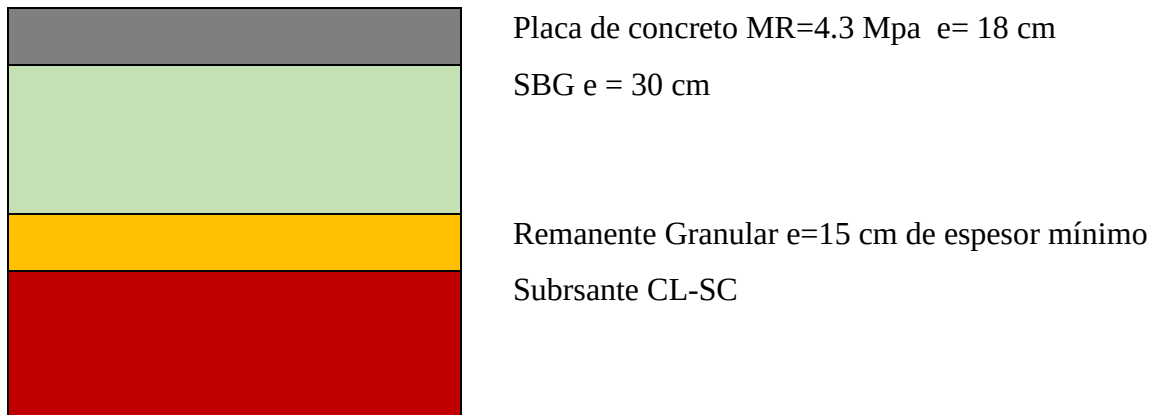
Perfil Vía Propuesto Pavimento Rígido
